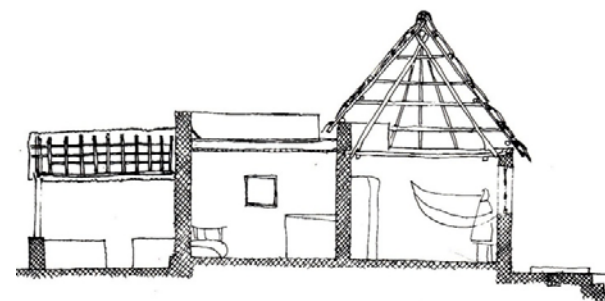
Corte y alzado interior. Muestra las alturas y desniveles en la tipología de la Casa Maya. Bolonchén, Campeche. Croquis por López Morales, F.J.
